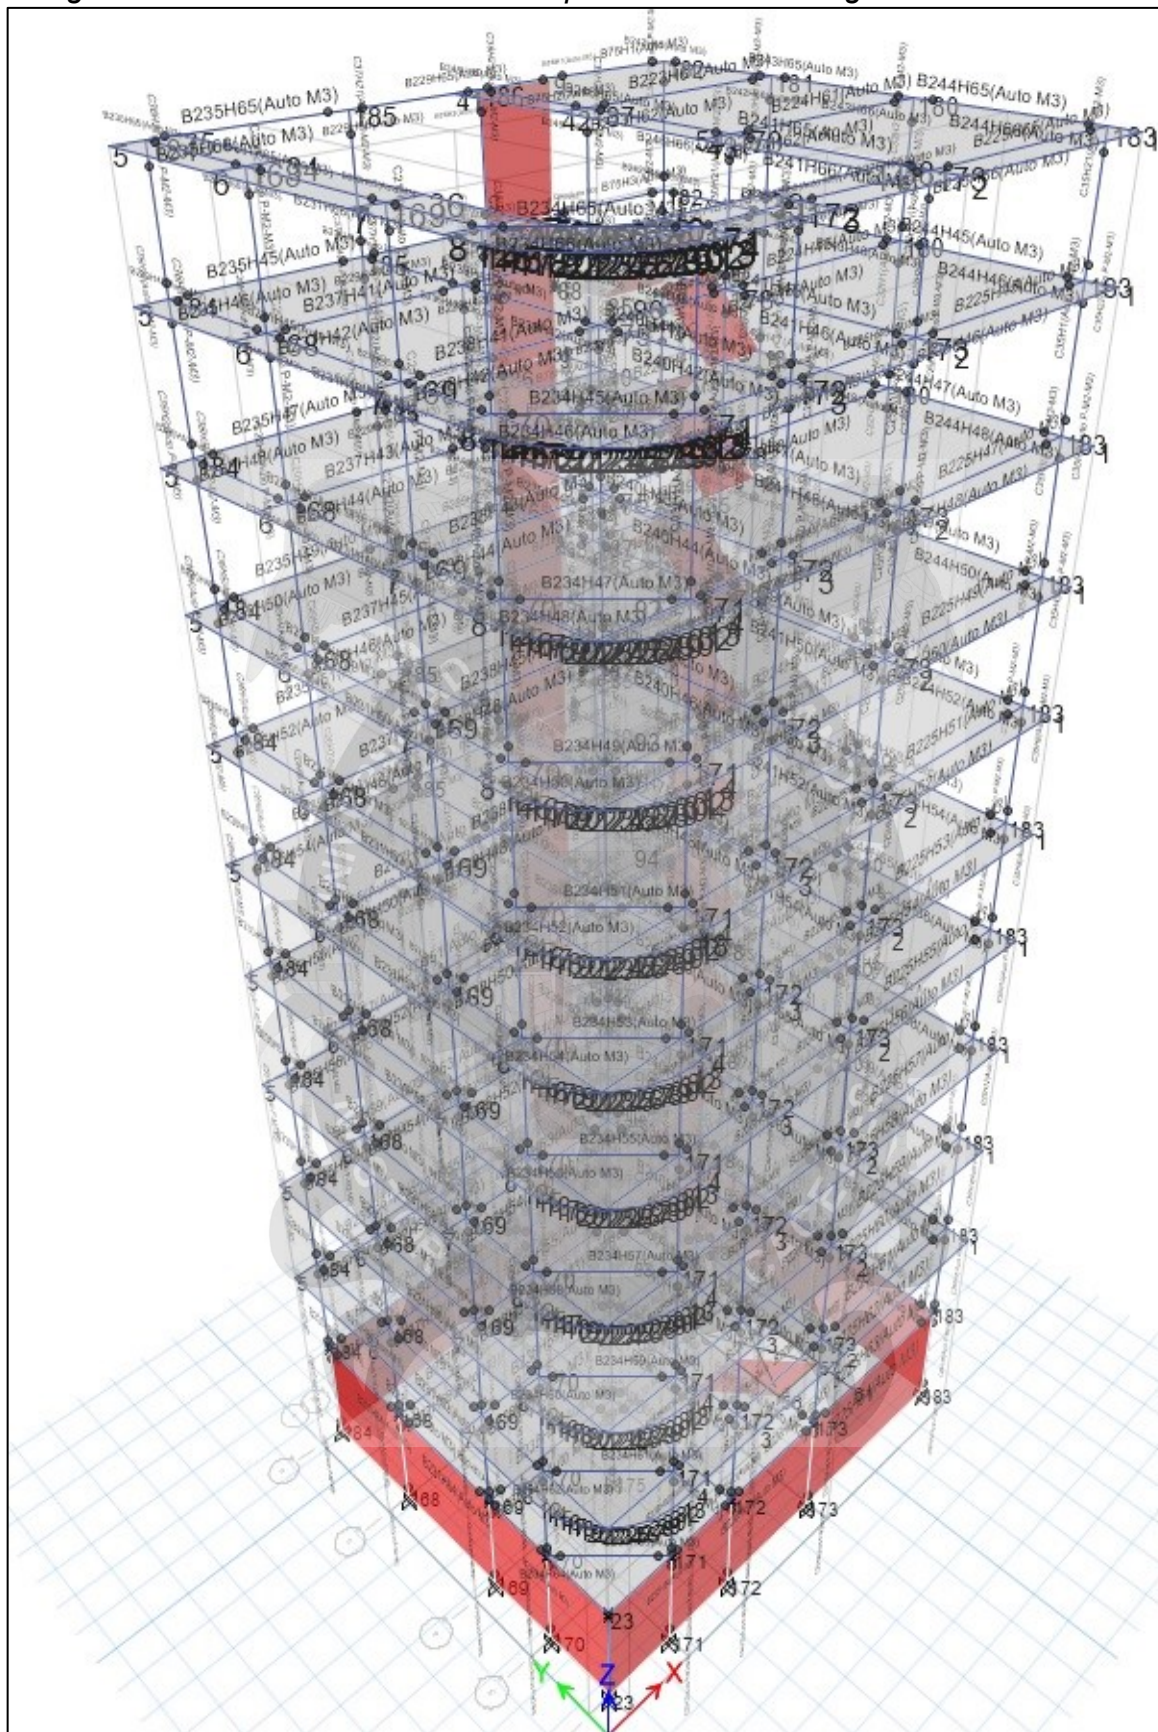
Asignación de rotulas plásticas al inicio y al final del elemento Columna
